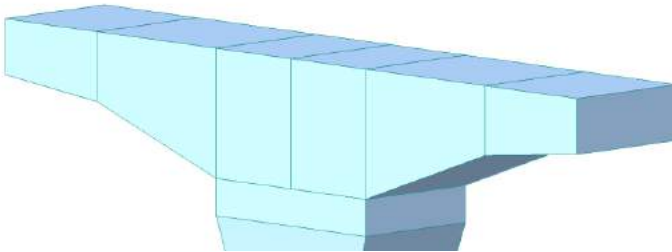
1. Permodelan Struktur Bangunan Bawah
